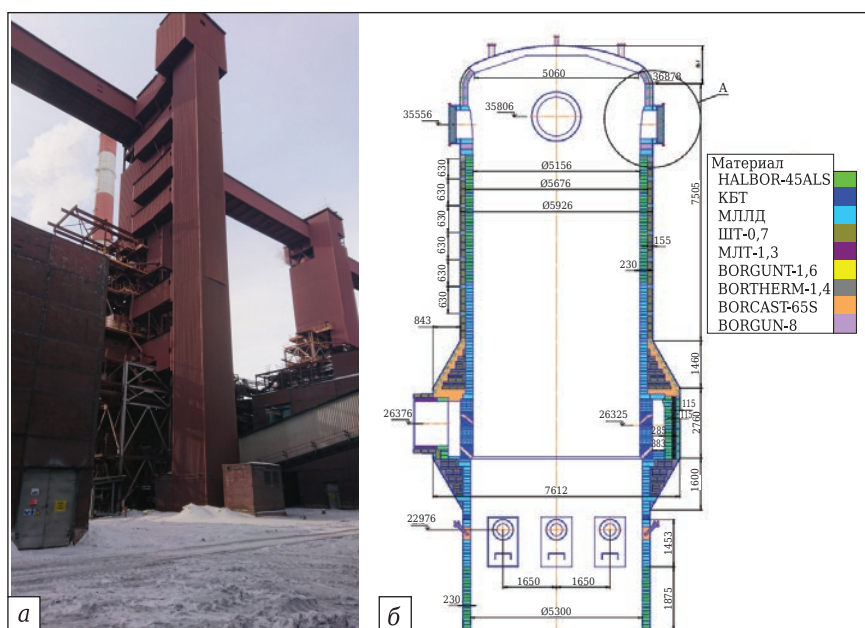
Установка металлизации окатышей: а — внешний вид печи; б — дизайн футеровки
